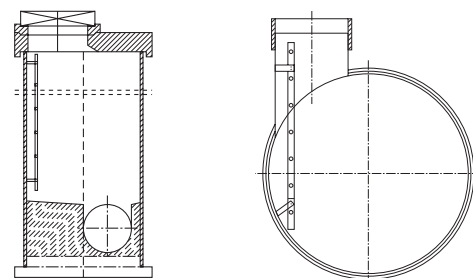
Стандартный и тангенциальный смотровой колодец
